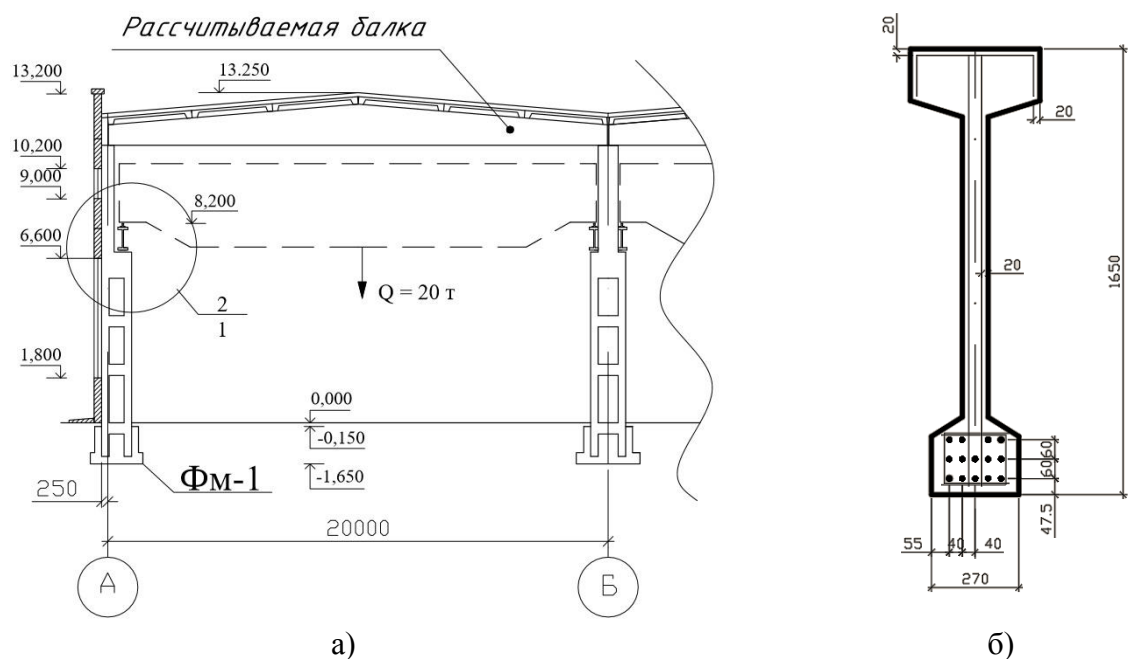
а) фрагмент поперечного сечения промышленного здания с указанием рассчитываемой балки; б) схема армирования поперечного сечения балки
